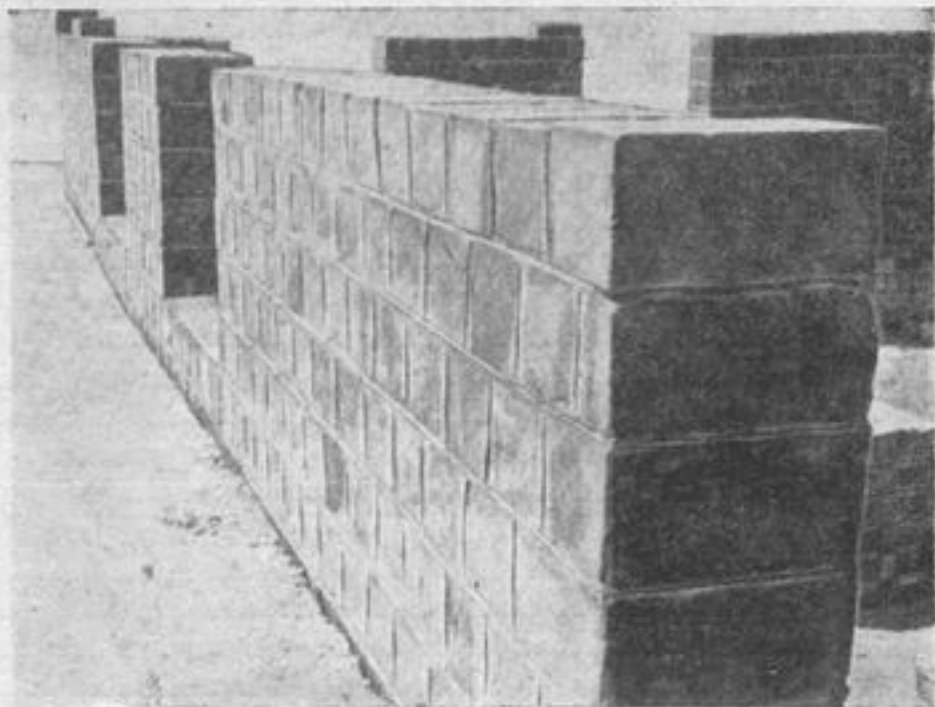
Фрагмент стены жилого дома из грунтосиликатных блэков.
